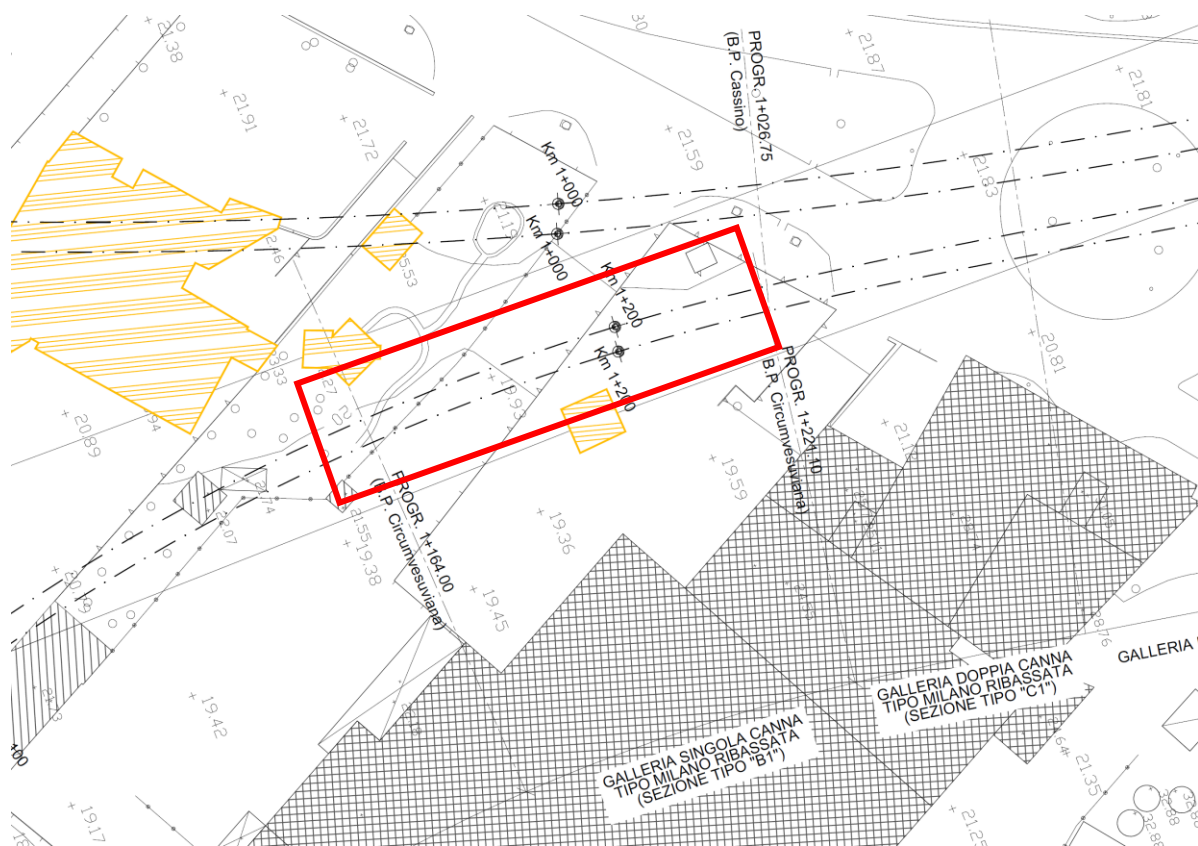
Planimetria di inquadramento tratta – Stato attuale
